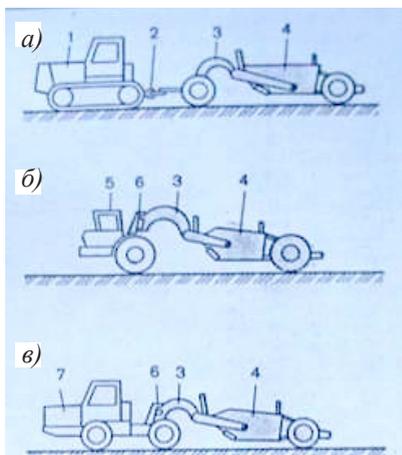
Скреперы: а – прицепной; б – самоходный одноосный; в) самоходные двухосный; 1, 7 – гусеничный и колесный тракторы; 2, 6 – сцепное и седельно-сцепное устройства; 3 – рама; 4 – ковш; 5 – одноосный тягач
